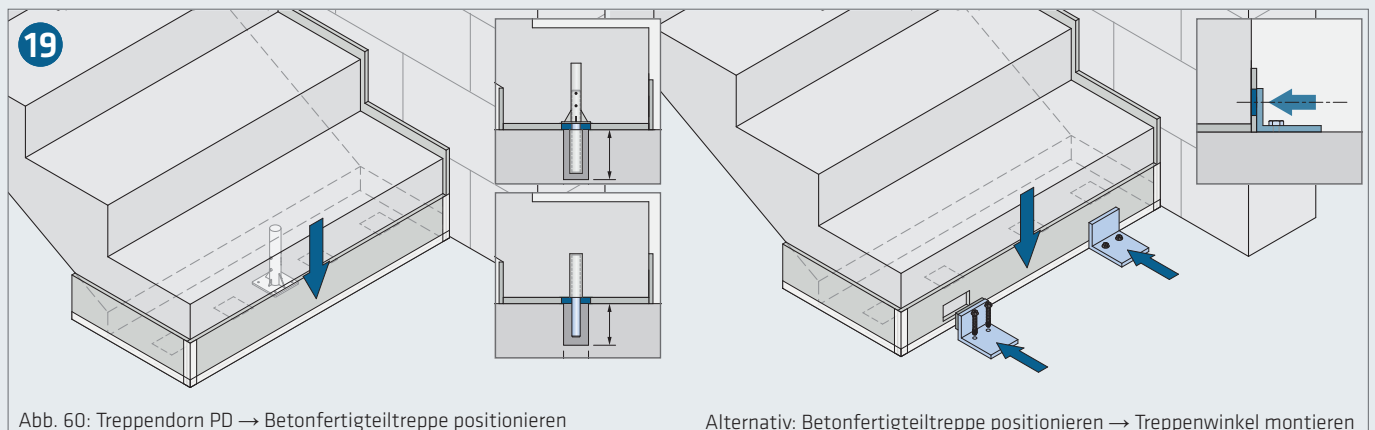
Treppendorn PD → Betonfertigteiltreppe positionieren
